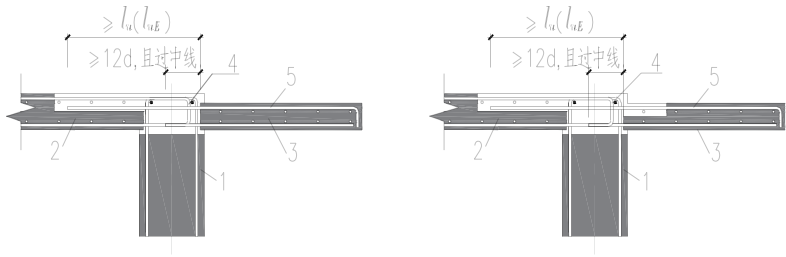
变阶预制混凝土板支座构造示意图
